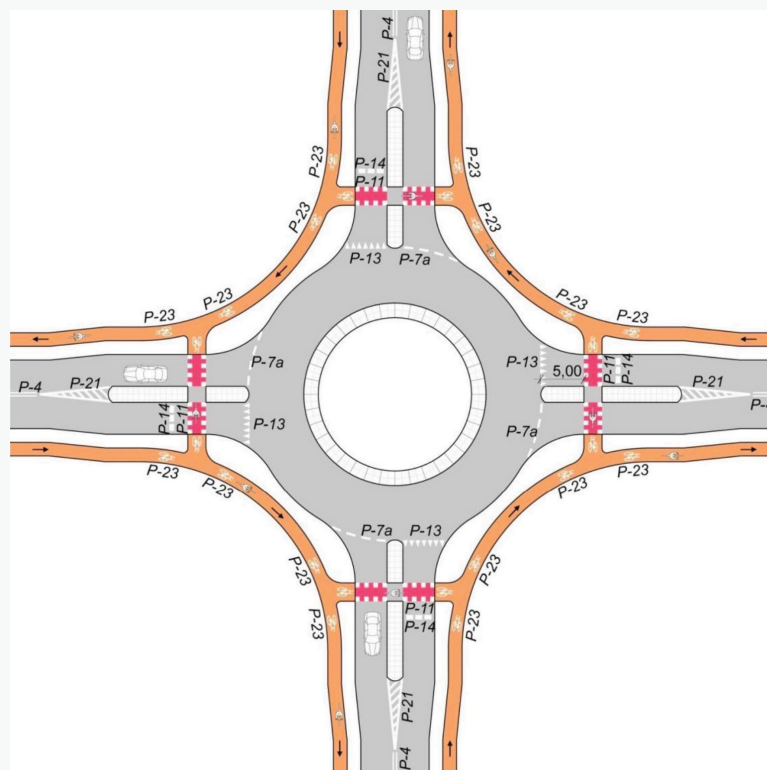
Małe rondo o wymiarach przyjaznych dla rowerzystów, opracowanie własne
